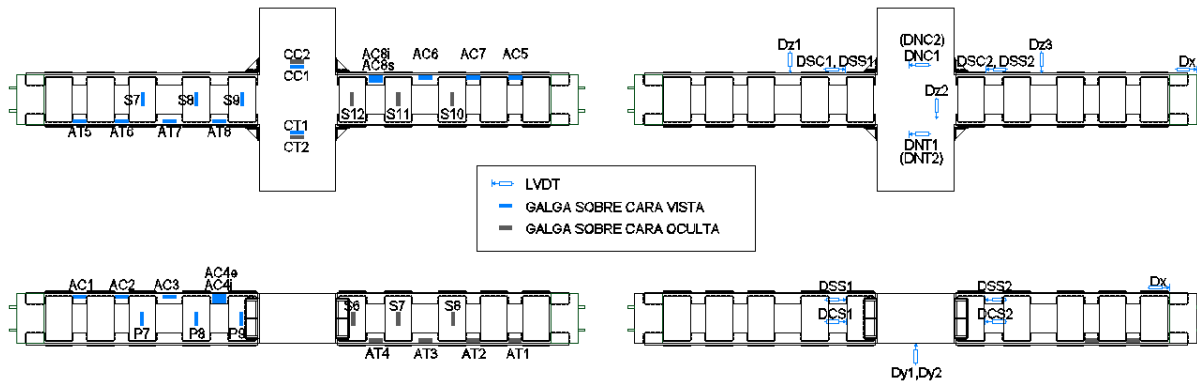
Instrumentación dispuesta en las probetas reforzadas
